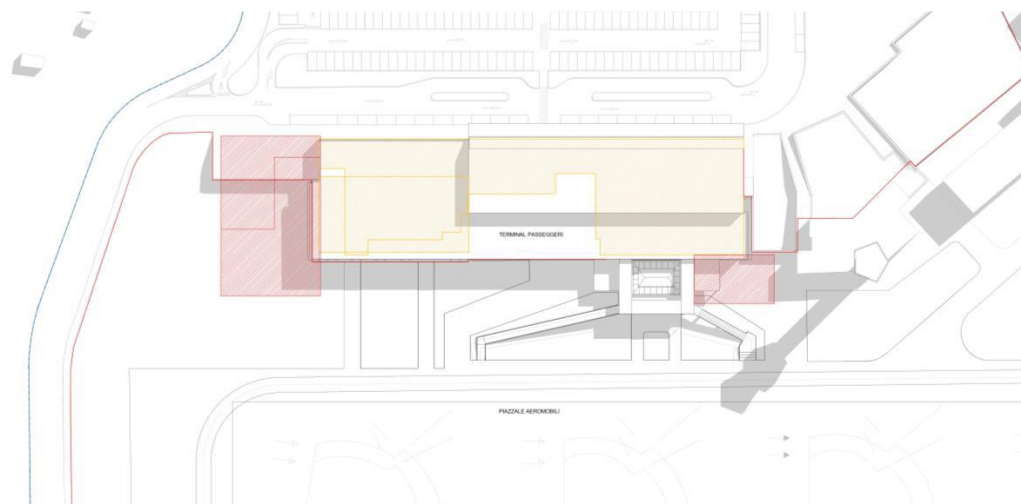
Planimetria generale di inquadramento del piano copertura dell'aerostazione
